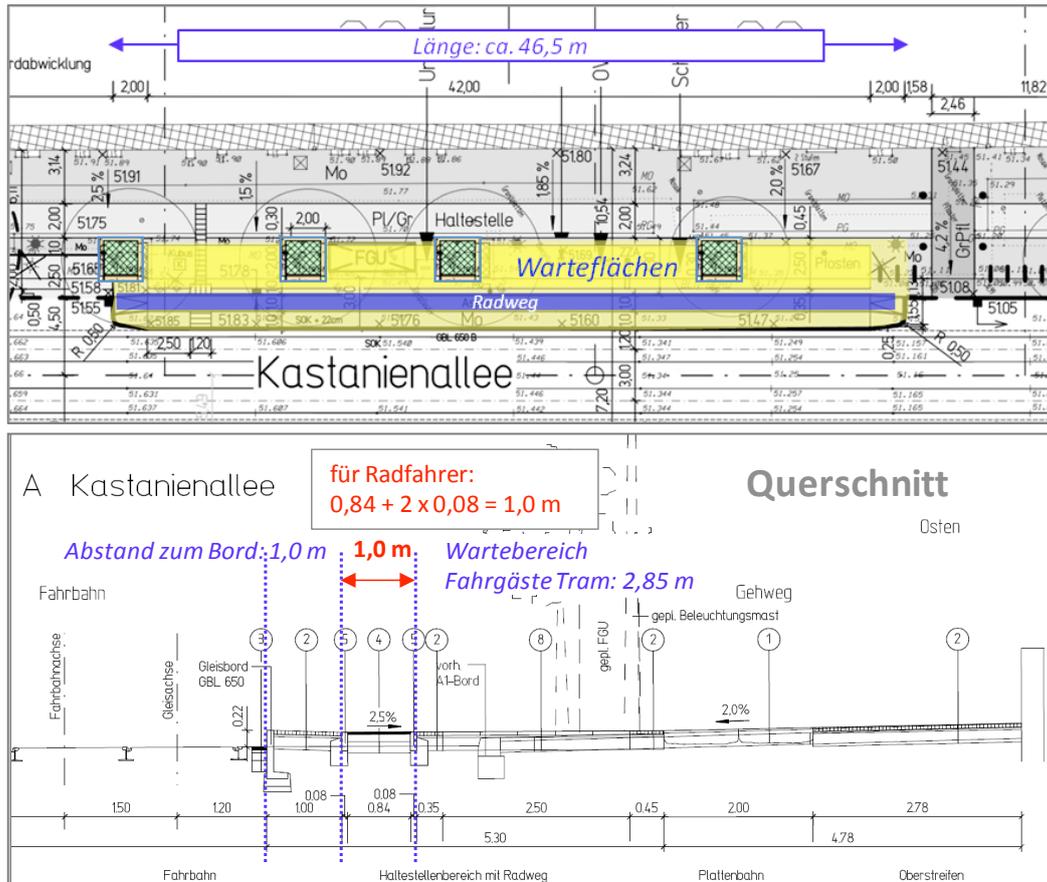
Geplante Haltestellenkaps in der Kastanienallee (Auszüge aus den Planunterlagen)
